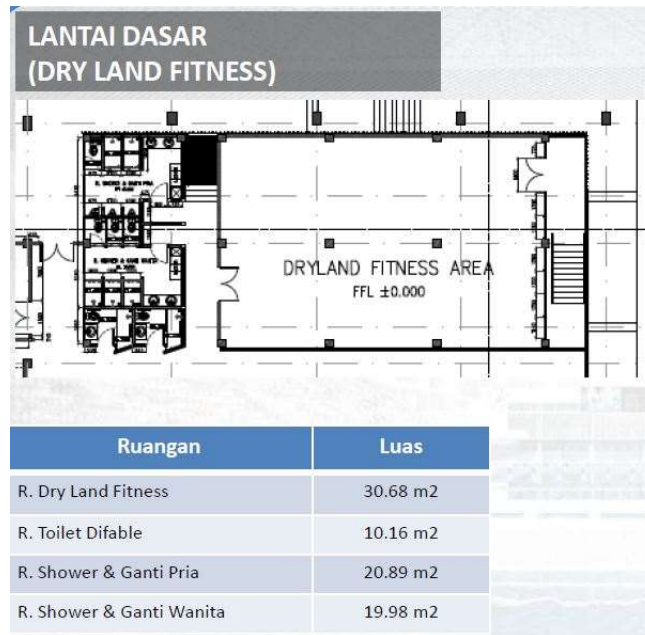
Denah Lantai Dasar (Tribun Barat Baru) Stadion Akuatik GBK
